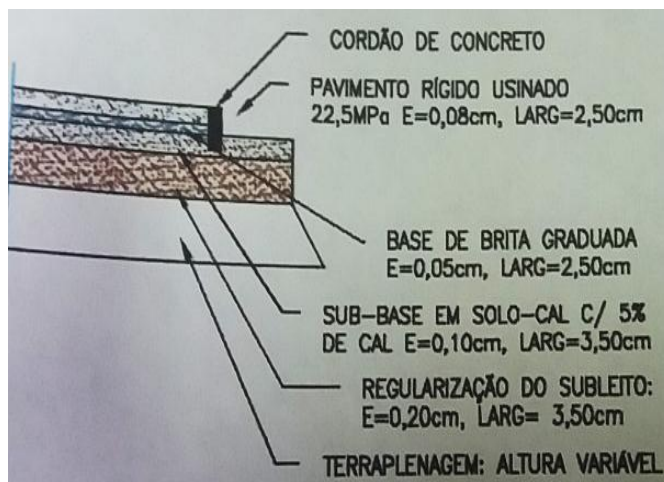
Corte esquemático da seção do pavimento rígido de ciclovia conforme o contrato 610/2011.
